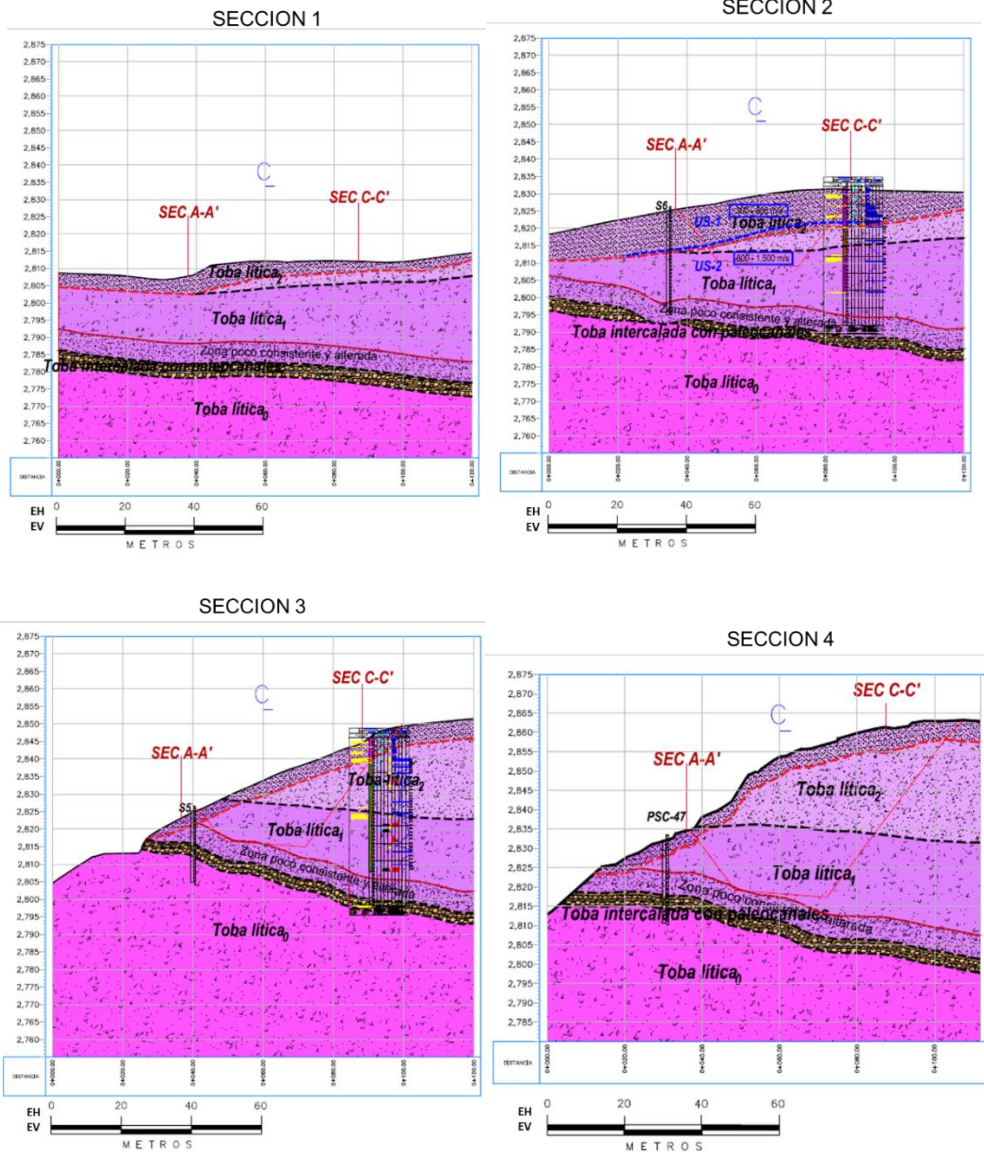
Secciones transversales realizadas en la zona de estudio.
